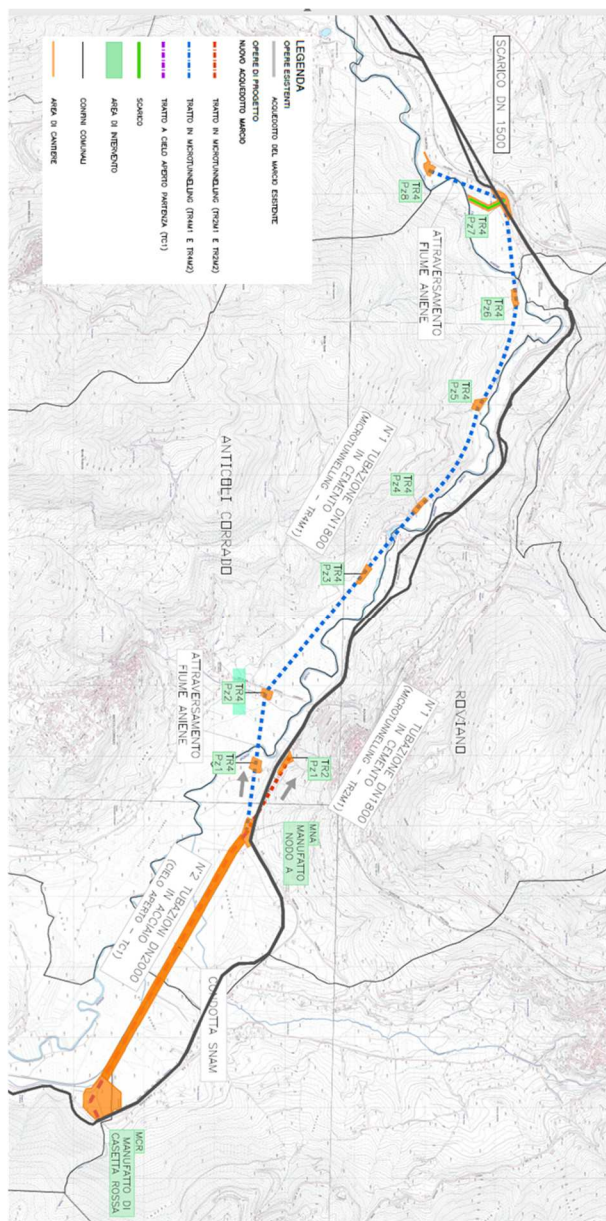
Planimetria fuori scala delle opere di progetto, aree di cantiere, viabilità ed interferenze.
